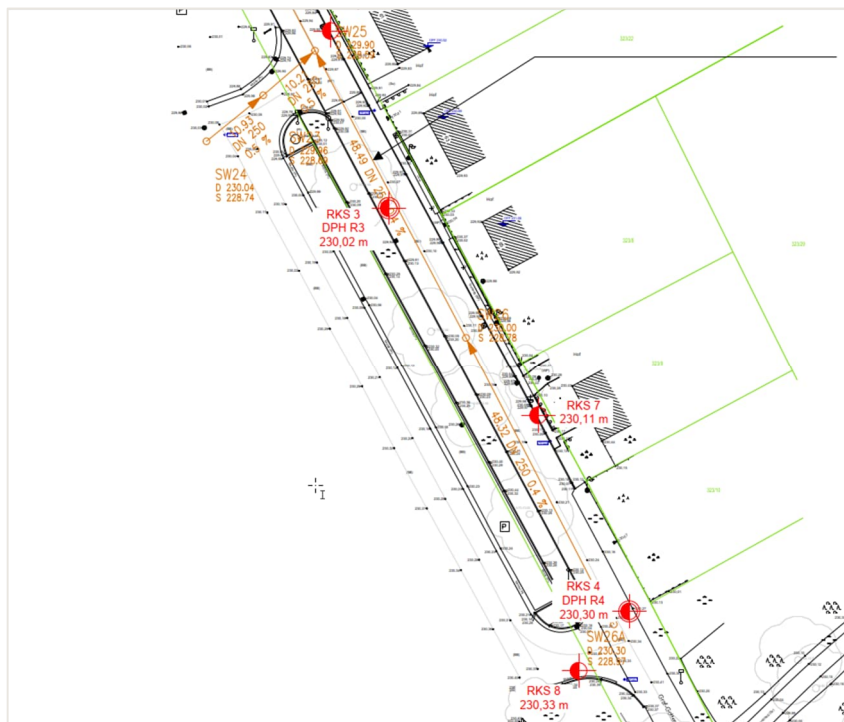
Ausschnitt 2 aus Lageplan Baugrund
